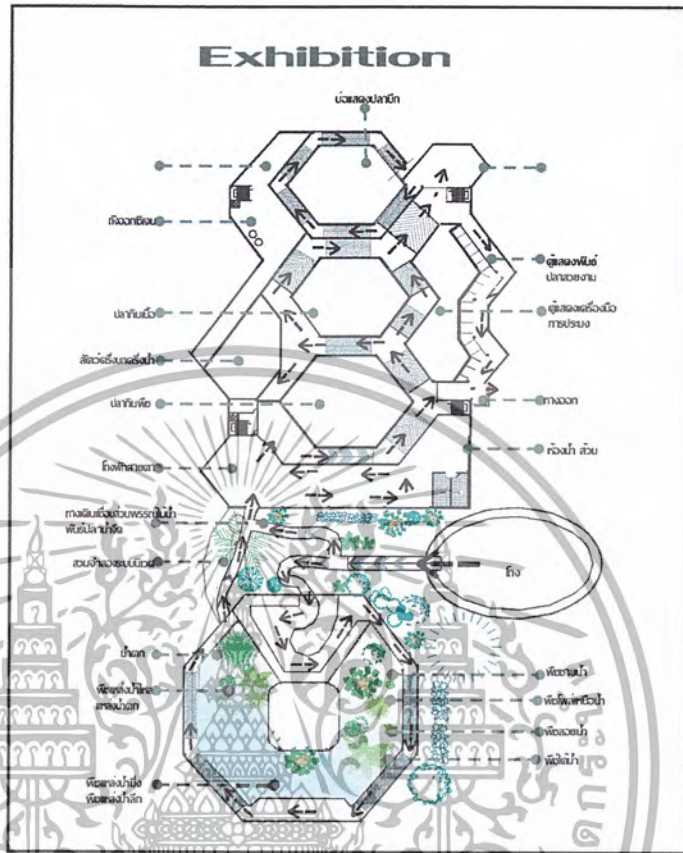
แสดง GROUND FLOOR PLAN
